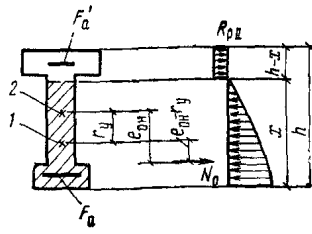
Схема усилий и эпюры напряжений в поперечном сечении элемента при расчете его по образованию трещин, нормальных к продольной оси элемента, в зоне сечения, растянутой от действия усилия предварительного обжатия 1 — ядровая точка; 2 — центр тяжести приведенного сечения
